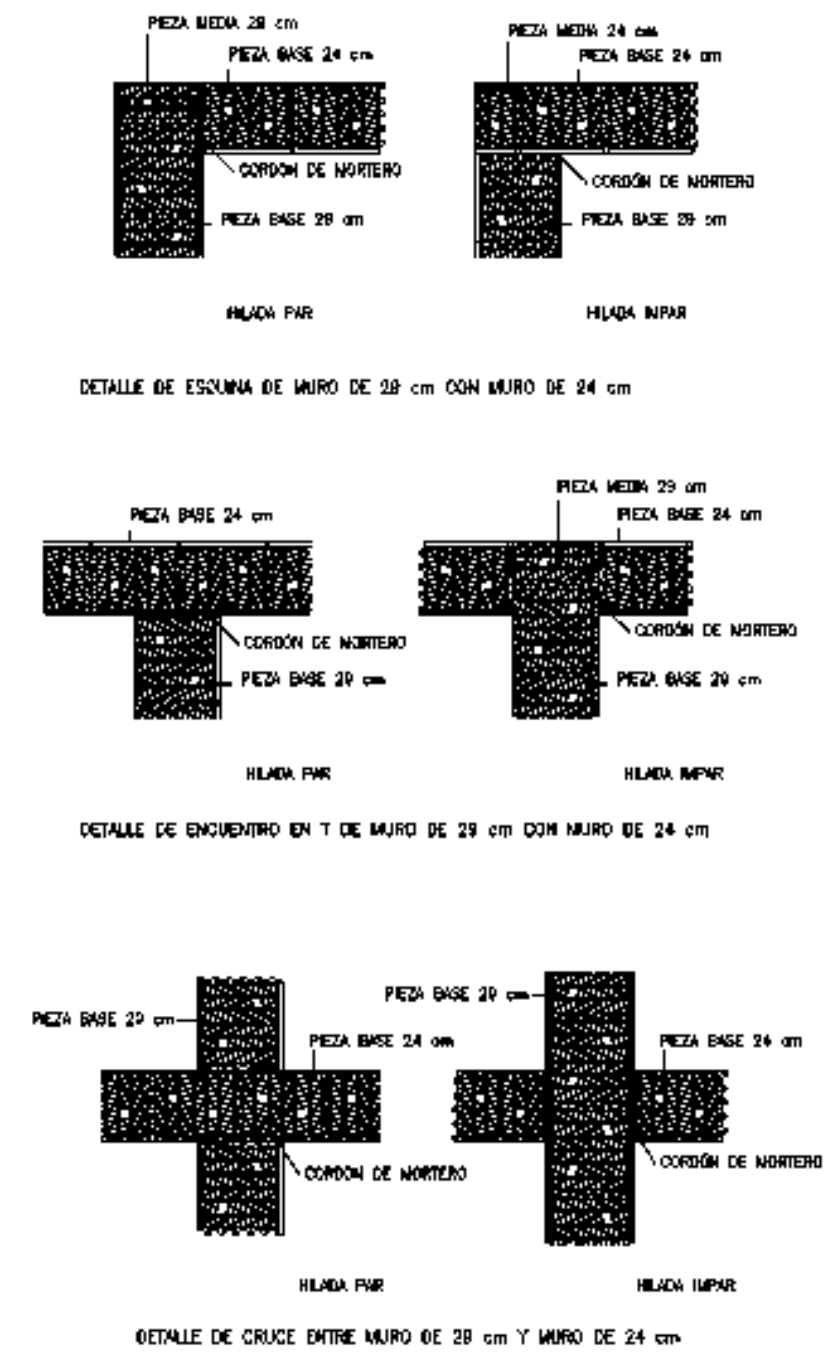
Detalles de encuentro de piezas de 29 cm con piezas de 24 cm.
